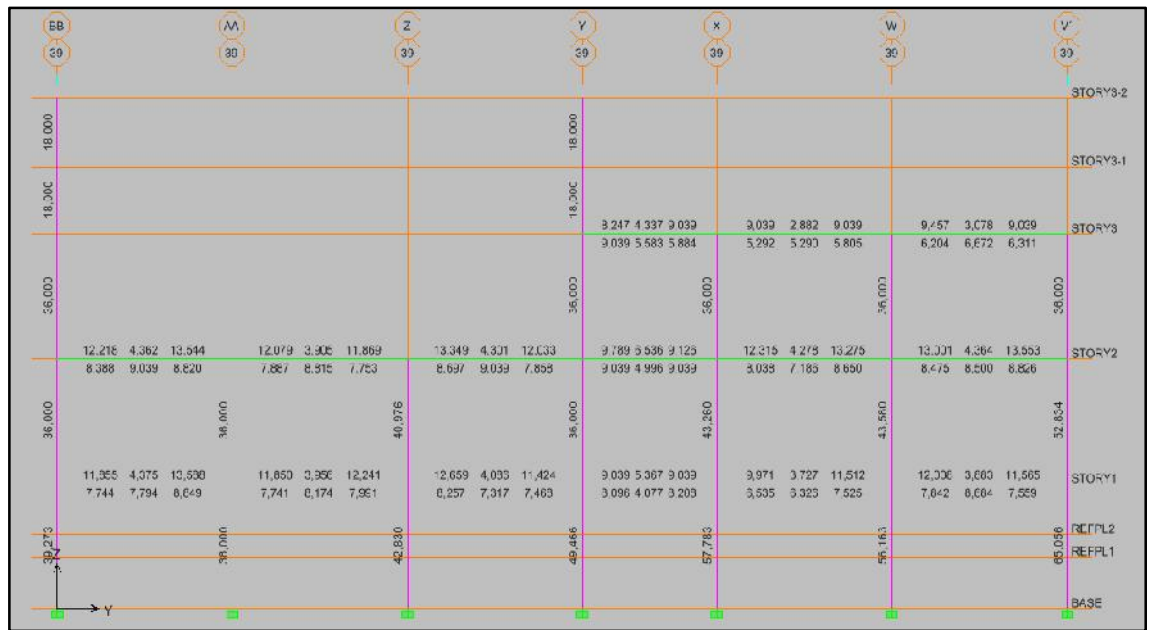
Acero en vigas pórtico 39, Consulta Externa II
